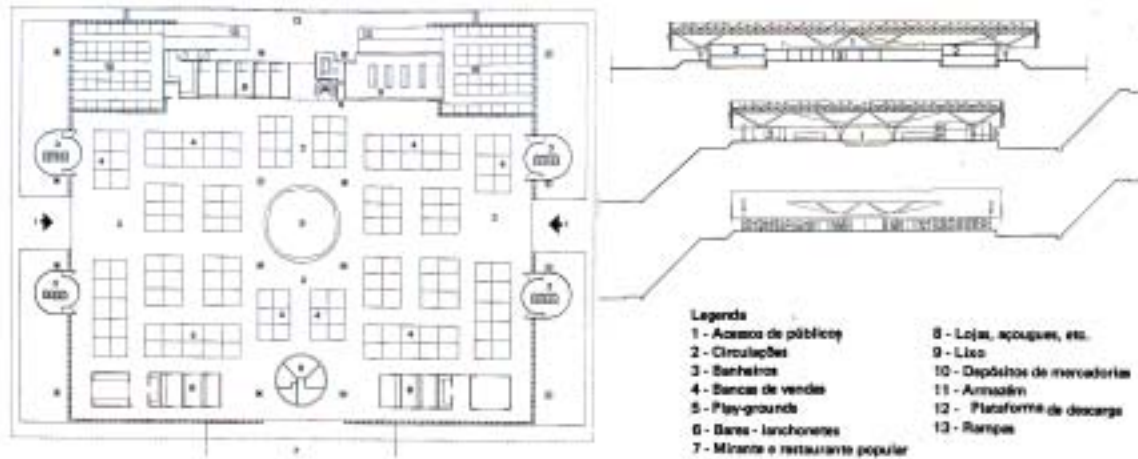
Mercado Distrital do Cruzeiro (1972): planta, cortes e elevação norte.
